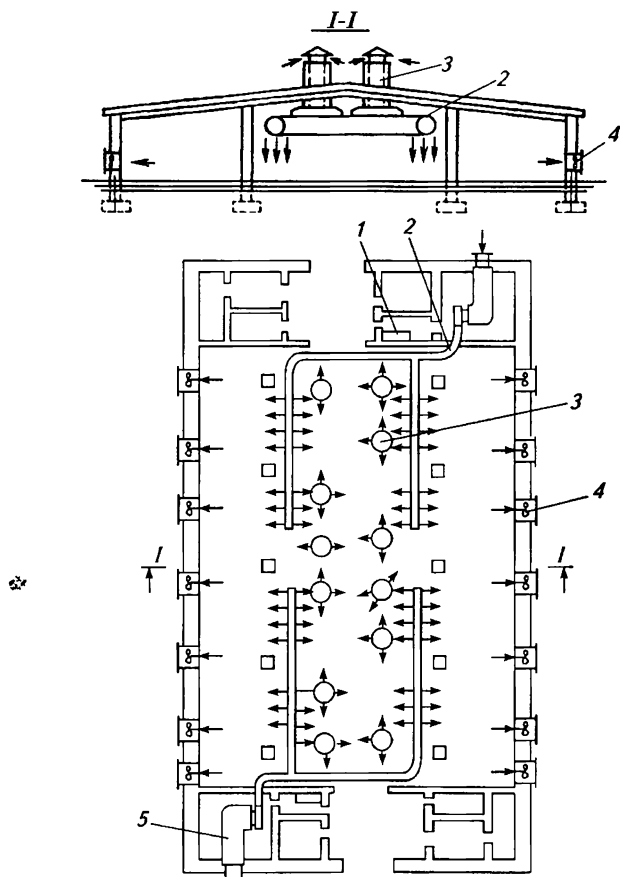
Система вентиляции с вытяжкой воздуха из нижней зоны при помощи осевых вентиляторов, расположенных в боковых стенах помещения:
